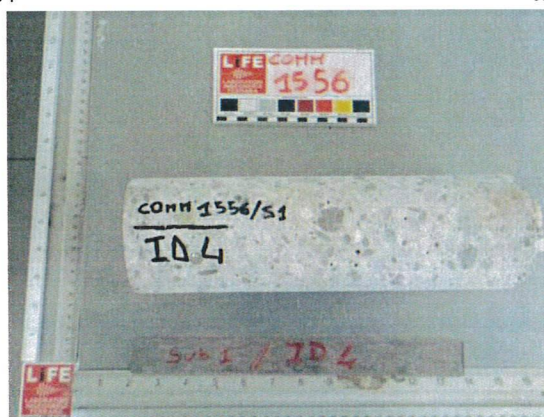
accettazione fotografica del materiale prelevato in situ – ID4
